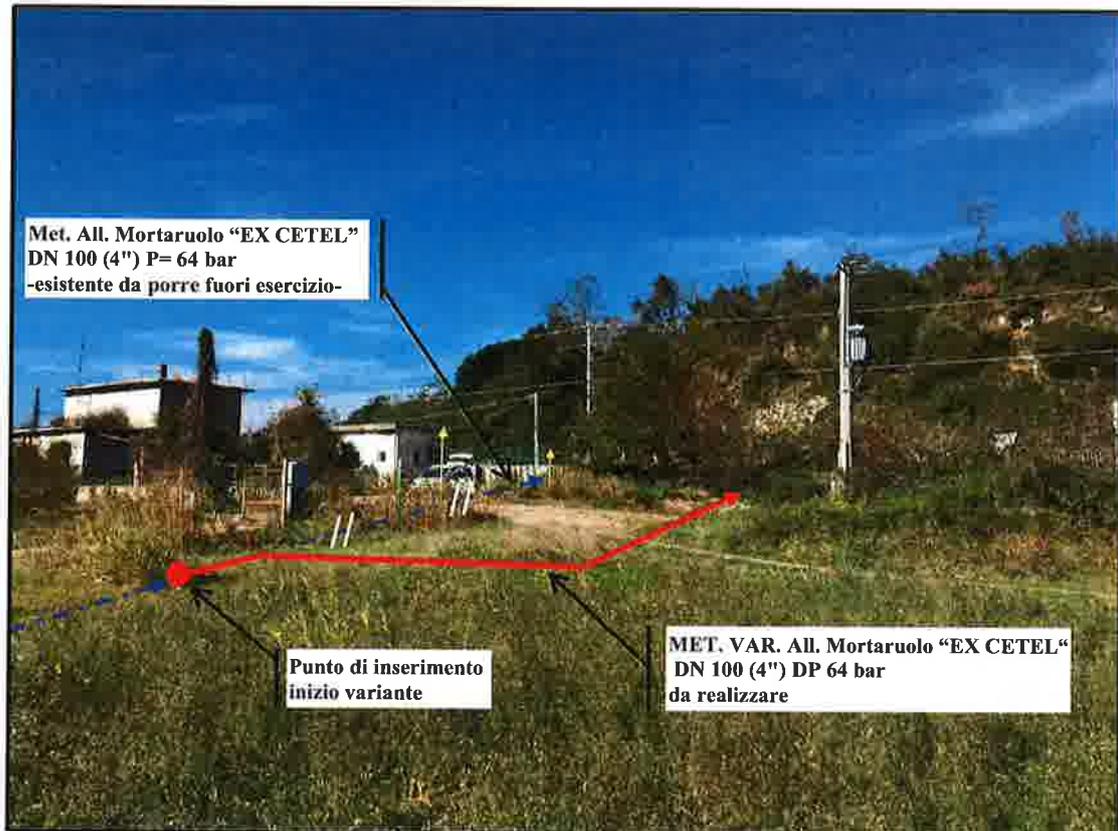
Vista inizio variante metanodotto da realizzare e attraversamento stradina in terra
